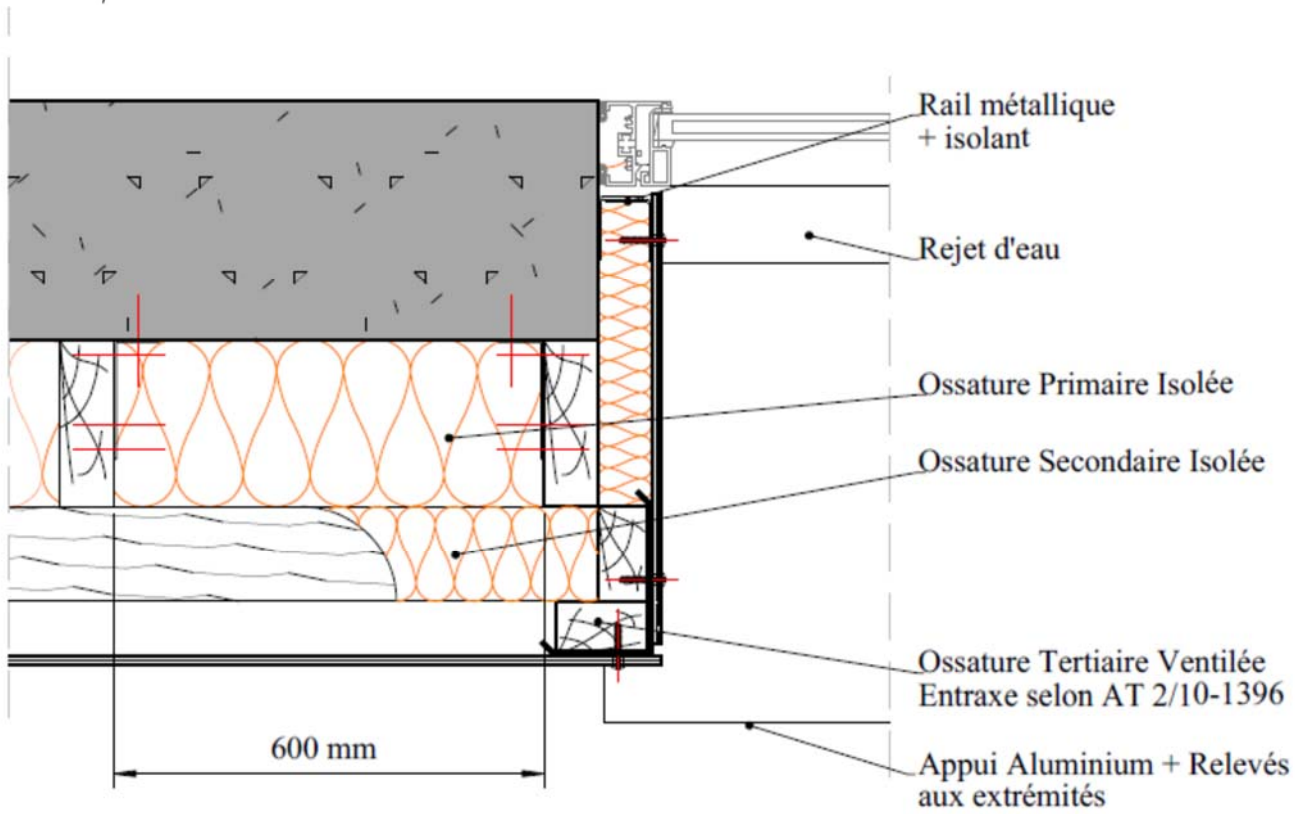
Réseaux croisés sur BA - Coupe sur tableau
